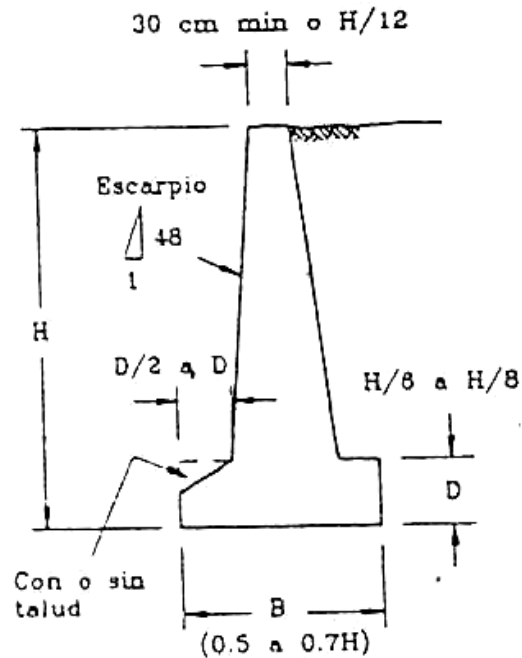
Predimensionamiento para un muro de gravedad (CFE; 1981: A.3-9)
